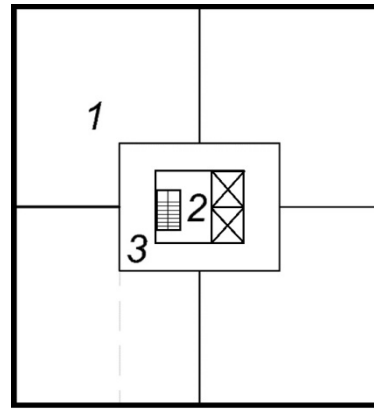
План точечного жилого дома (point block): 1-жилые квартиры, 2-лестнично-лифтовой узел, 3-внутренний коридор.
